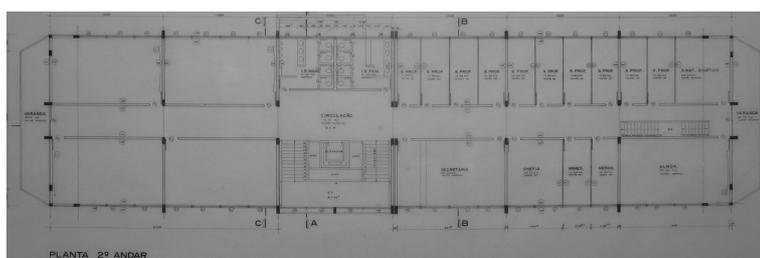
Planta do segundo pavimento de um bloco-módulo padrão de três pavimentos [1977].
